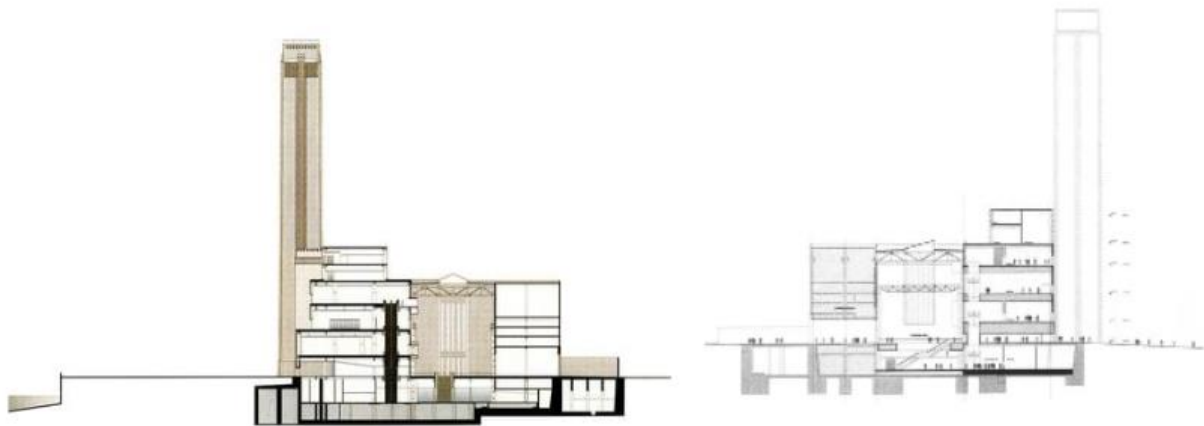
Sección transversal de la torre y la galería. Fuente: Plataforma Arquitectura
